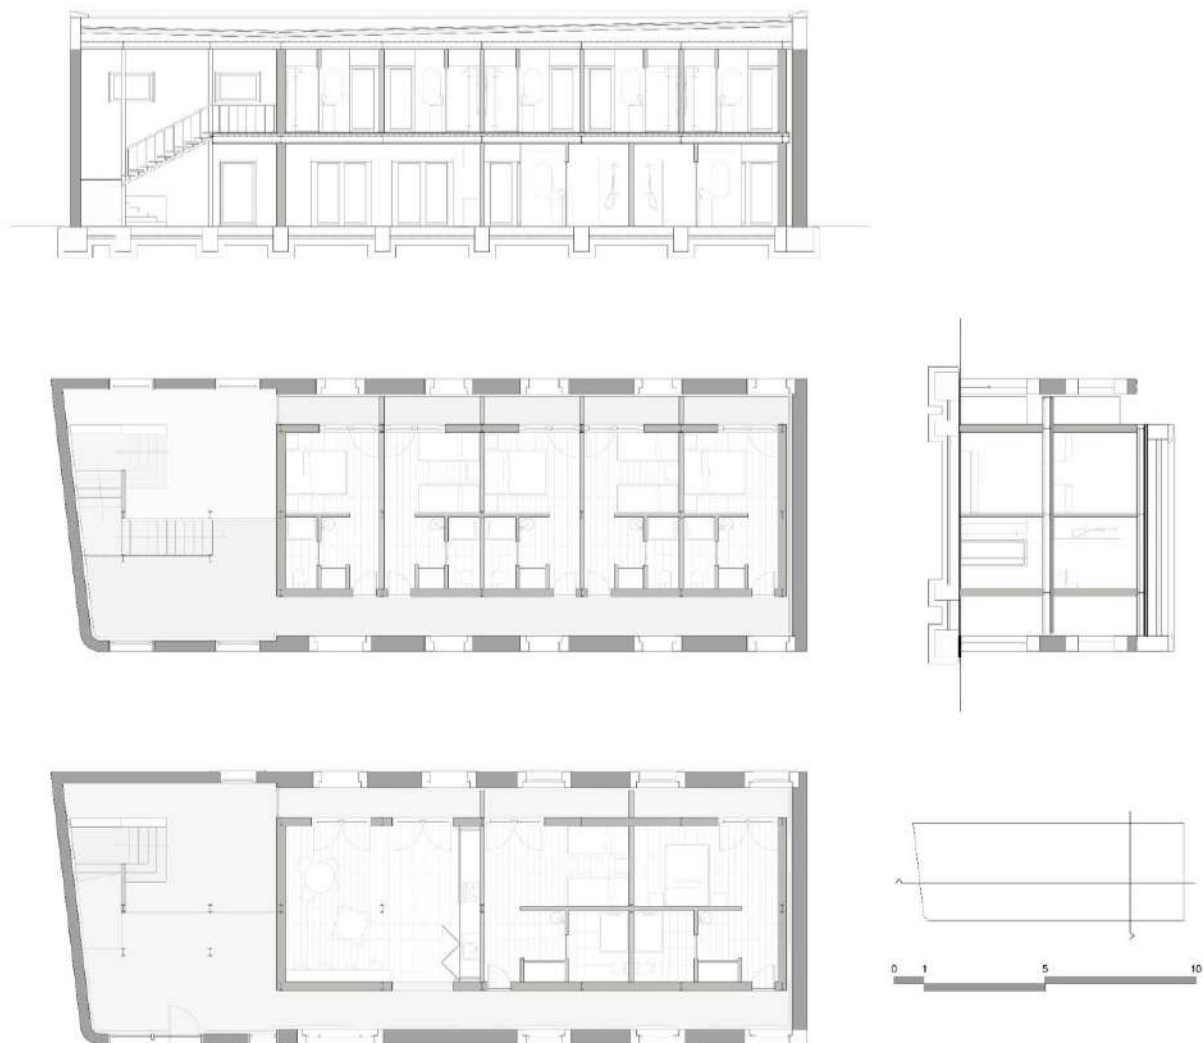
Albergaria. Corte longitudinal, plantas dos pisos térreo e superior e corte transversal.
